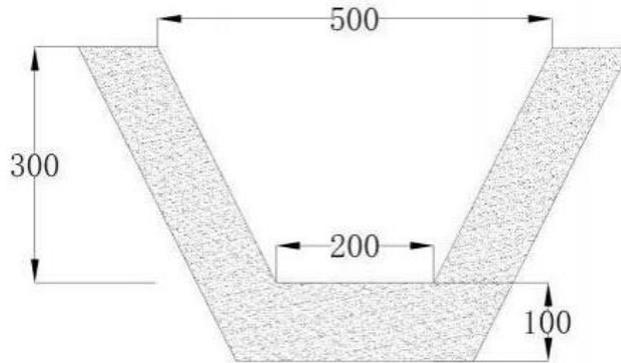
截（排）水沟结构断面图（图中尺寸单位为 mm）
